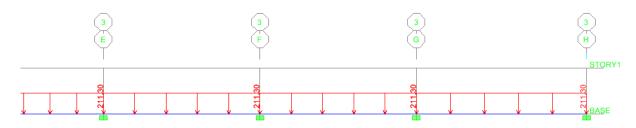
Schéma statique de la nervure ELS (sens longitudinal).
